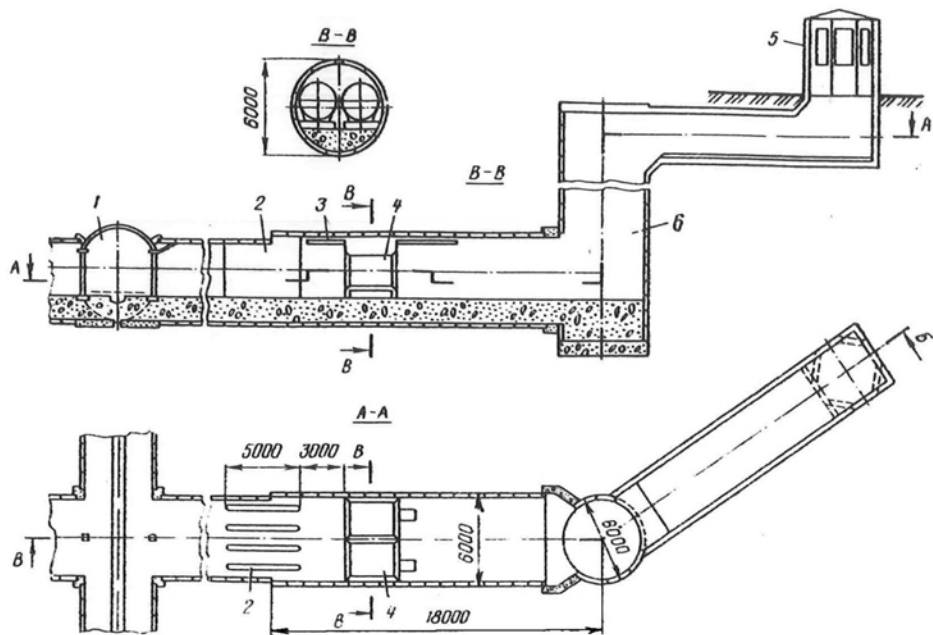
Вентиляционные сооружения на перегоне глубоко заложённой линии: 1 – перегонный туннель; 2 – шумоглушительные перегородки; 3 – монтажные балки; 4 – вентиляторы; 5 – вентиляционный киоск; 6 – ствол шахты
